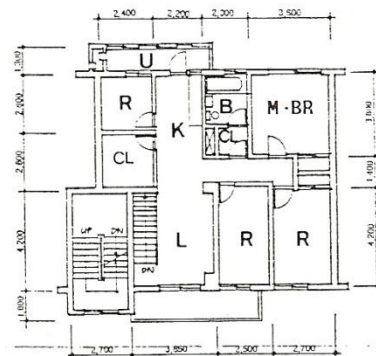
Obergeschossgrundriss einer doppelgeschossig
